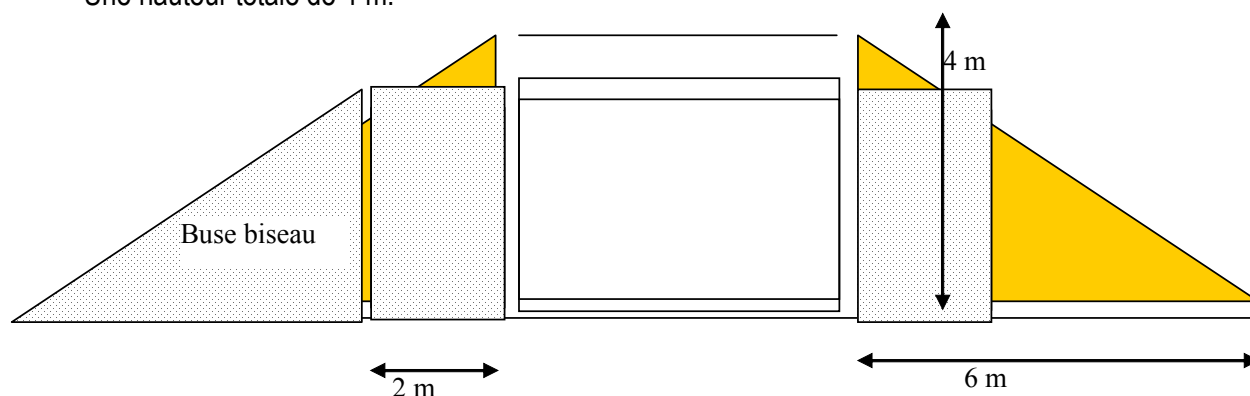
Schéma de l'ouvrage béton sans murs en retour
